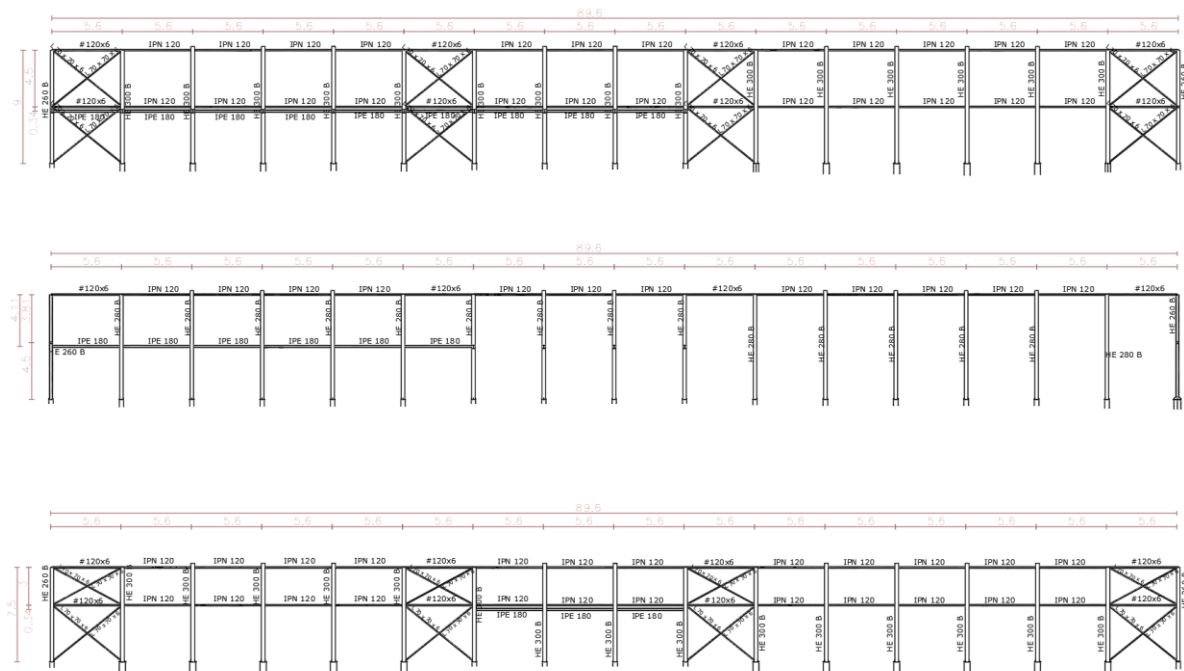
Fachadas laterales y pilares intermedios de la estructura.
